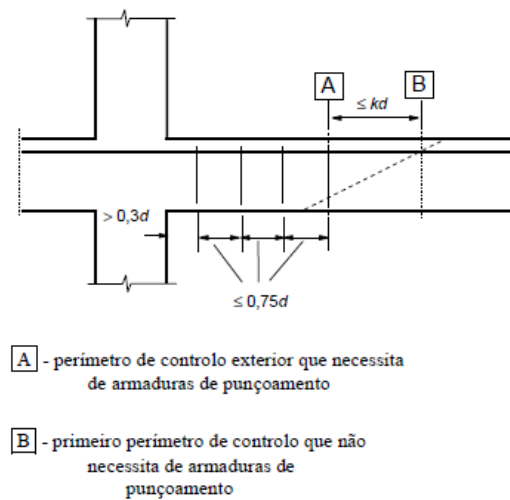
Disposição da armadura de punçoamento. [5]
